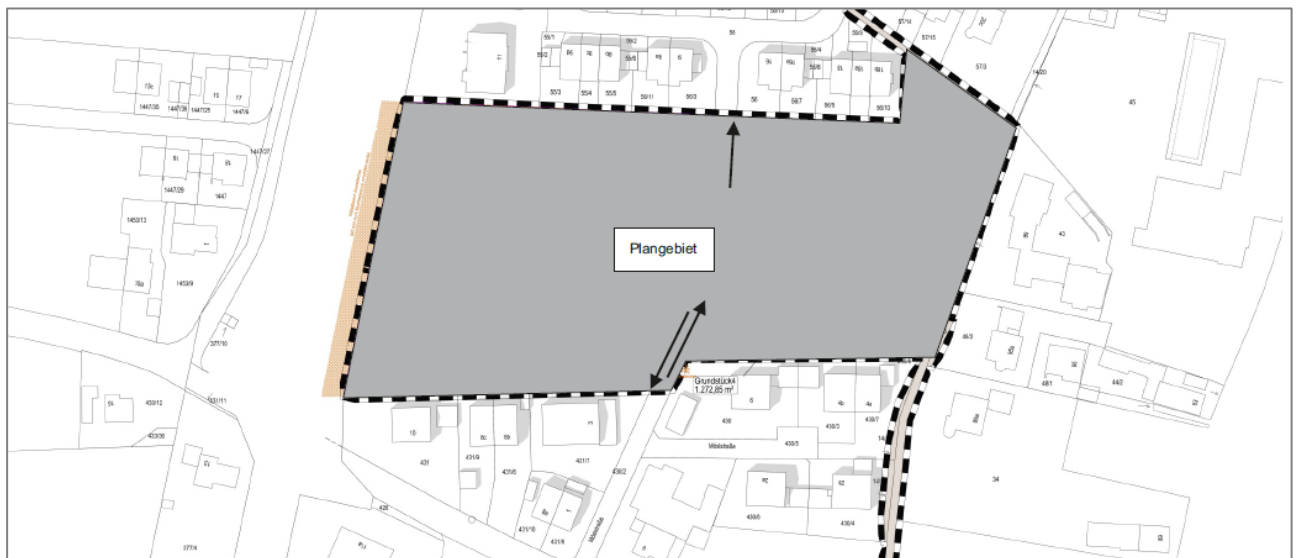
Erschließungsvariante VI, Plangrundlage: Planungsgruppe Strasser
